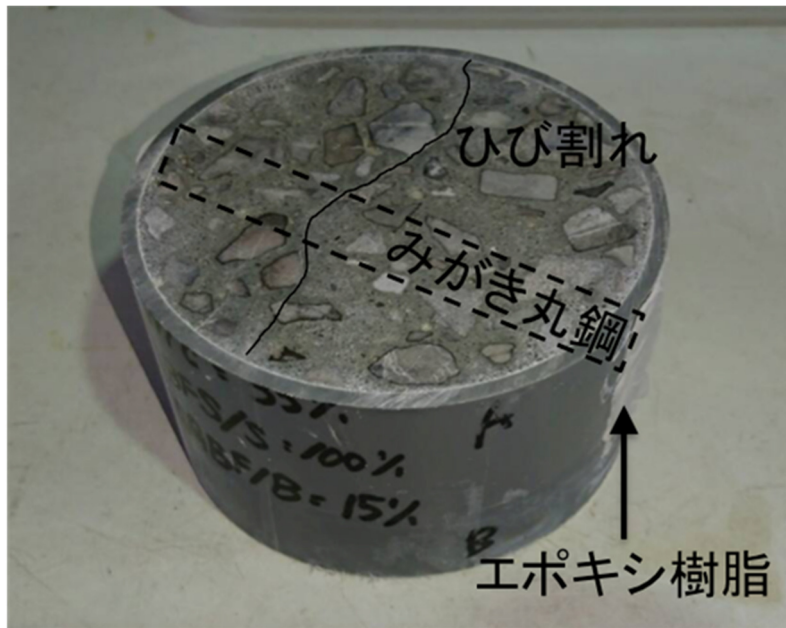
予めひび割れを入れたコンクリート供試体
